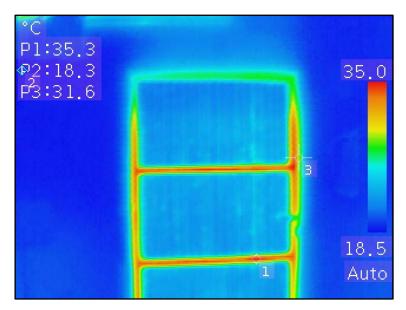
Imagen de la puerta de acceso peatonal al Pabellón ubicada en fachada SUR.
